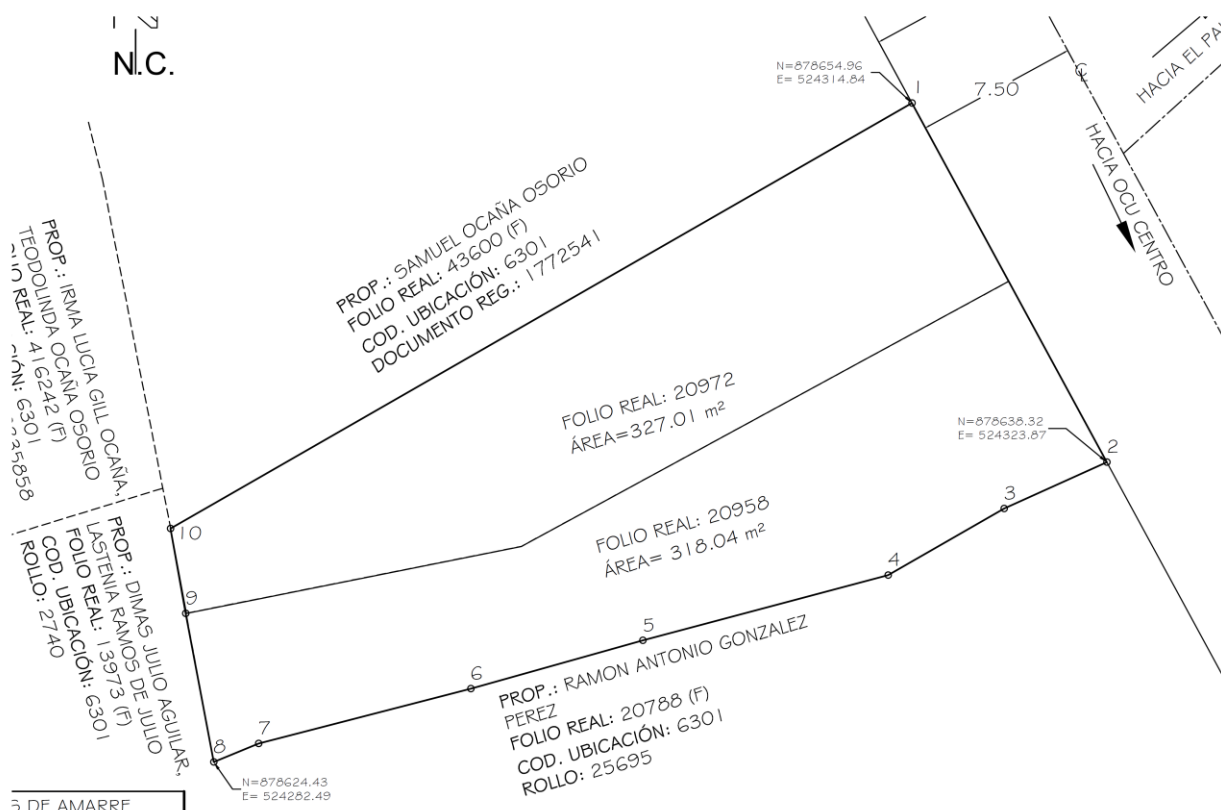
Ubicación y coordenadas UTM del proyecto “Plaza Liva”. Fuente. Planos del proyecto
